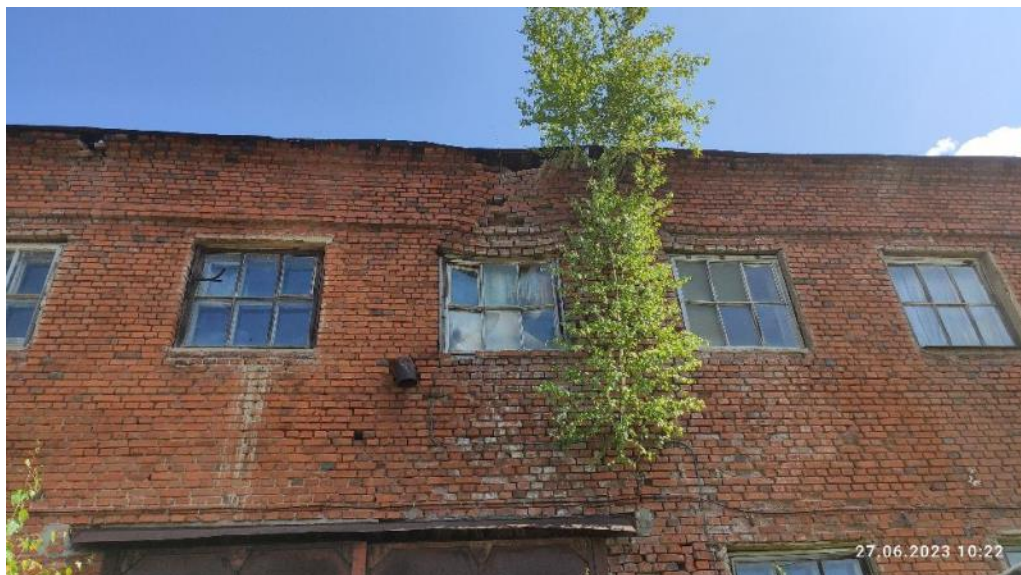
Выпадение отдельных кирпичей, разрушение кладки, рост деревьев в толще кладки стен (юго-западный фасад здания)
